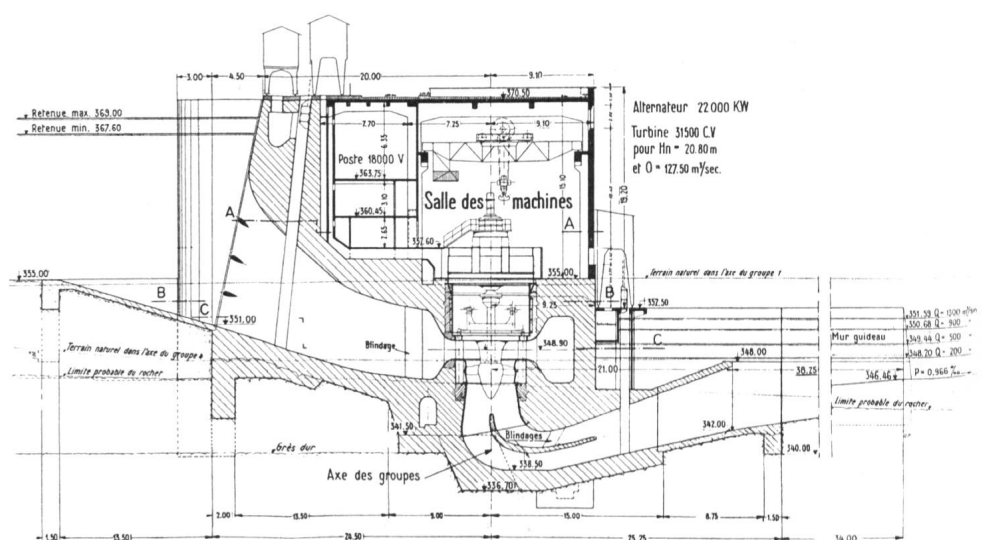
Salle des machines. Coupe transversale. Echelle 1 : 700.
